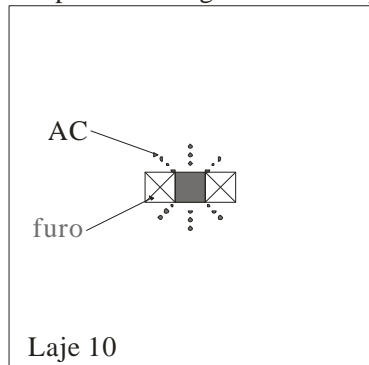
Características das lajes ensaiadas por Silva (2003)
